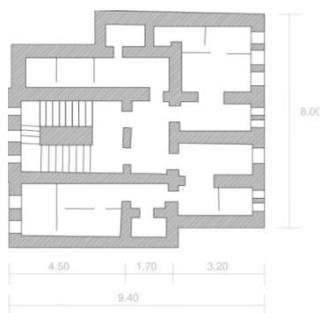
Planta tipo de casa torre. Elaboración propia a partir de Ortega (2008).
